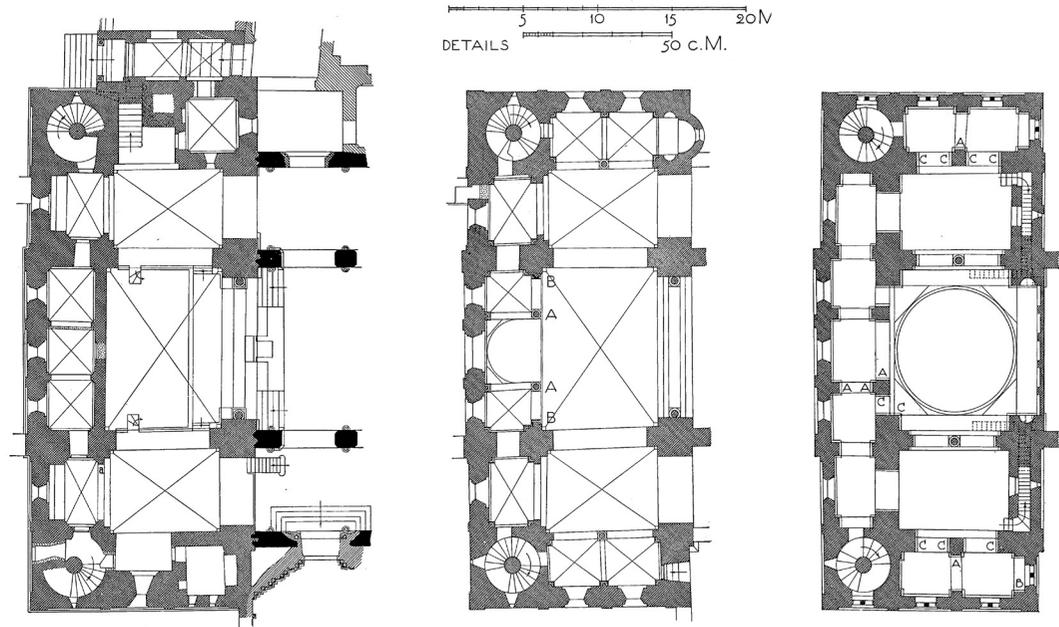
Maastricht, St. Servatius. Westbau, Geschossgrundrisse: Erdgeschoss, Emporengeschoss und Niveau über dem Westchor, sog. Keizerzaal.
